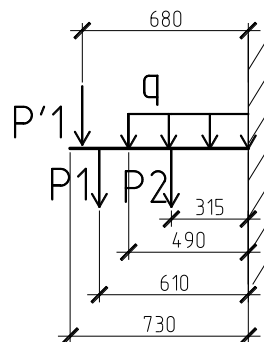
Расчетная схема приложения нагрузки в месте крепления СЖ-2 к колонне
